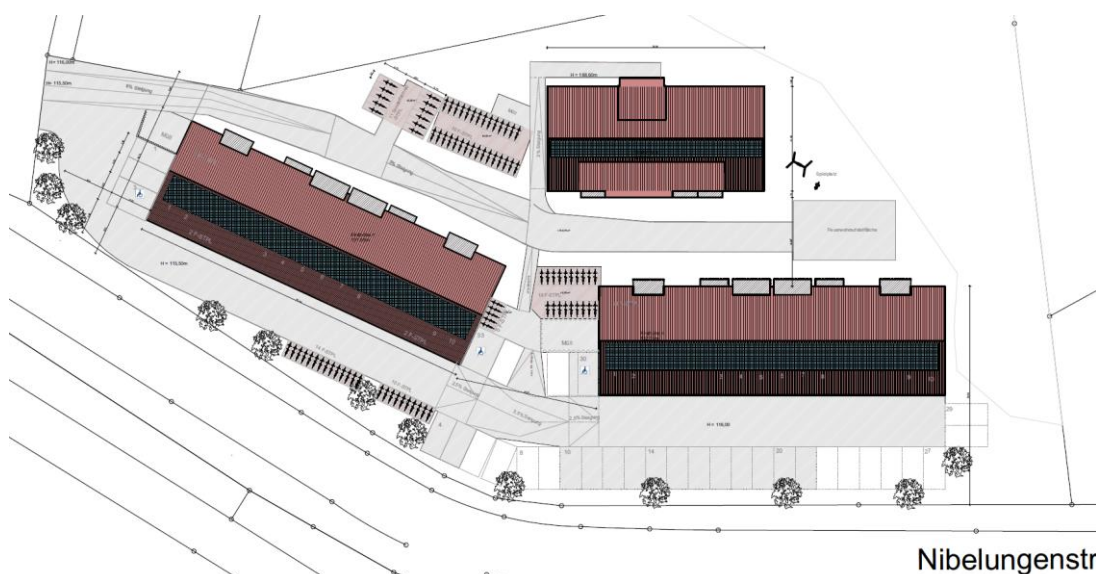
Lageplan des Vorhabens (unmaßstäblich, Bildquelle: WSW Baubetreuungs GmbH, Dezember 2025)
